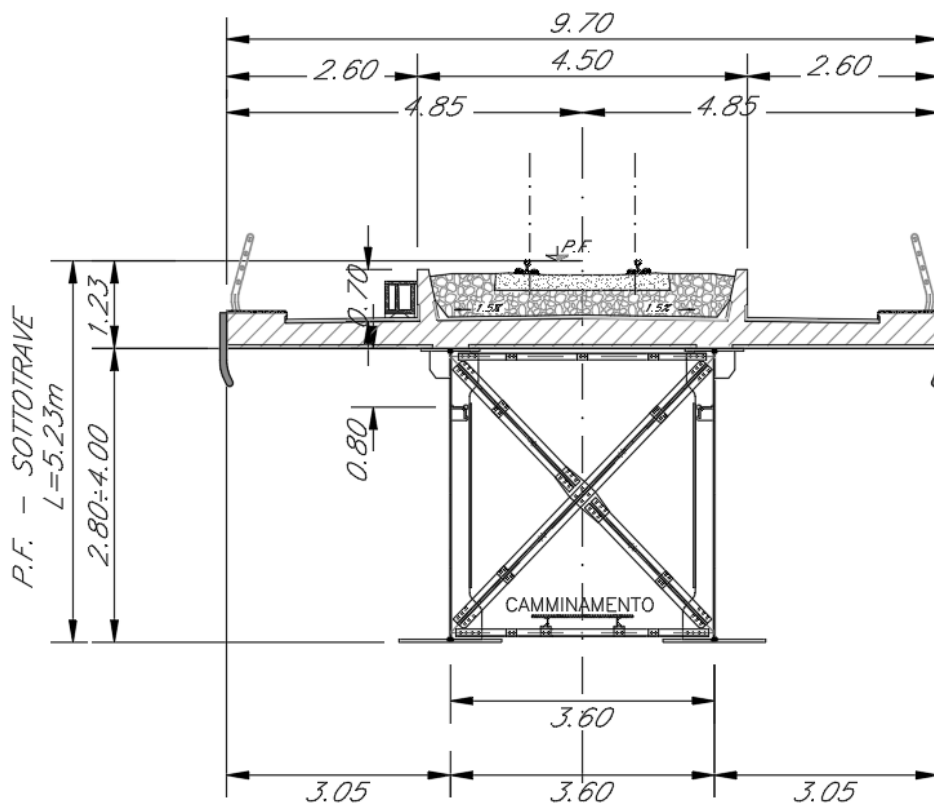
sezione trasversale dell'impalcato misto acc-clc 50m
